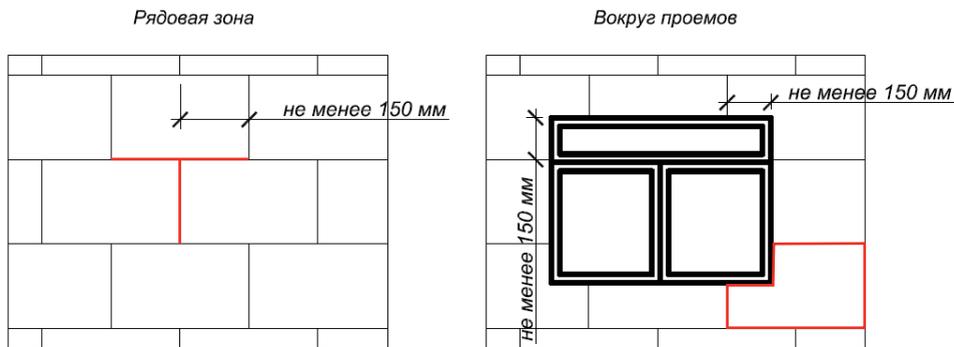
Схема установки плит на плоскости фасада и вокруг проемов
